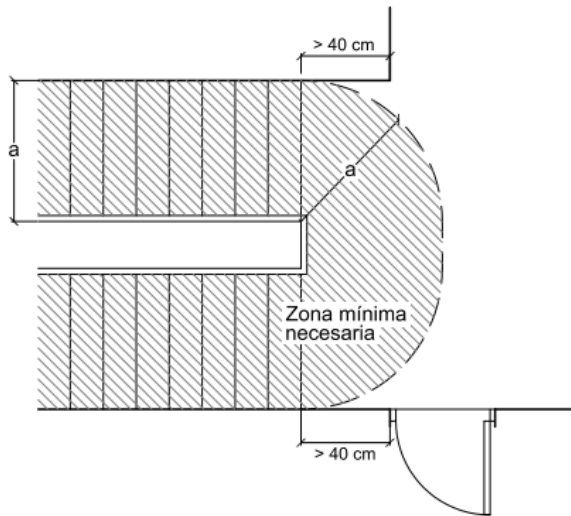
Cambio de dirección entre los planos – Fuente: CTE
